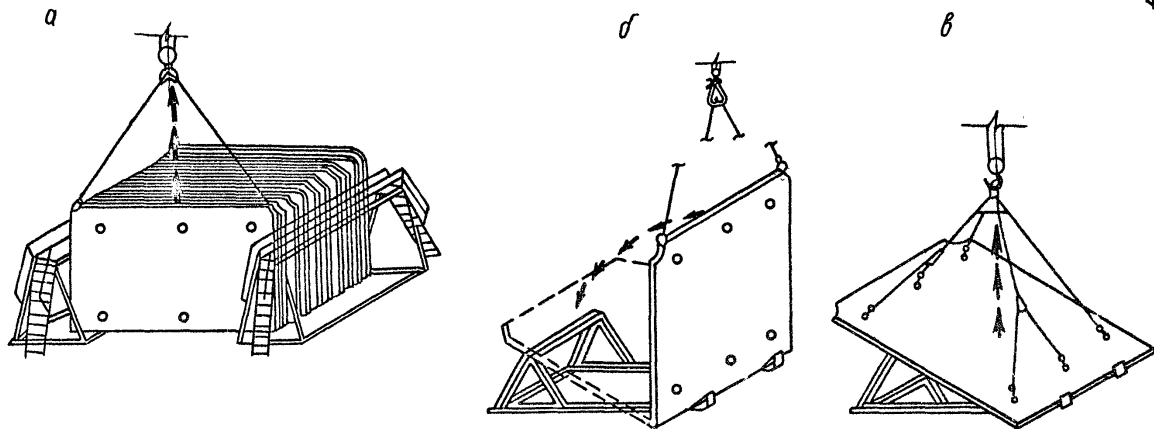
Последовательность перестропки панелей перекрытия: а-подъем панели перекрытия из кассеты; б-кантование панели перекрытия; в-перестропка
